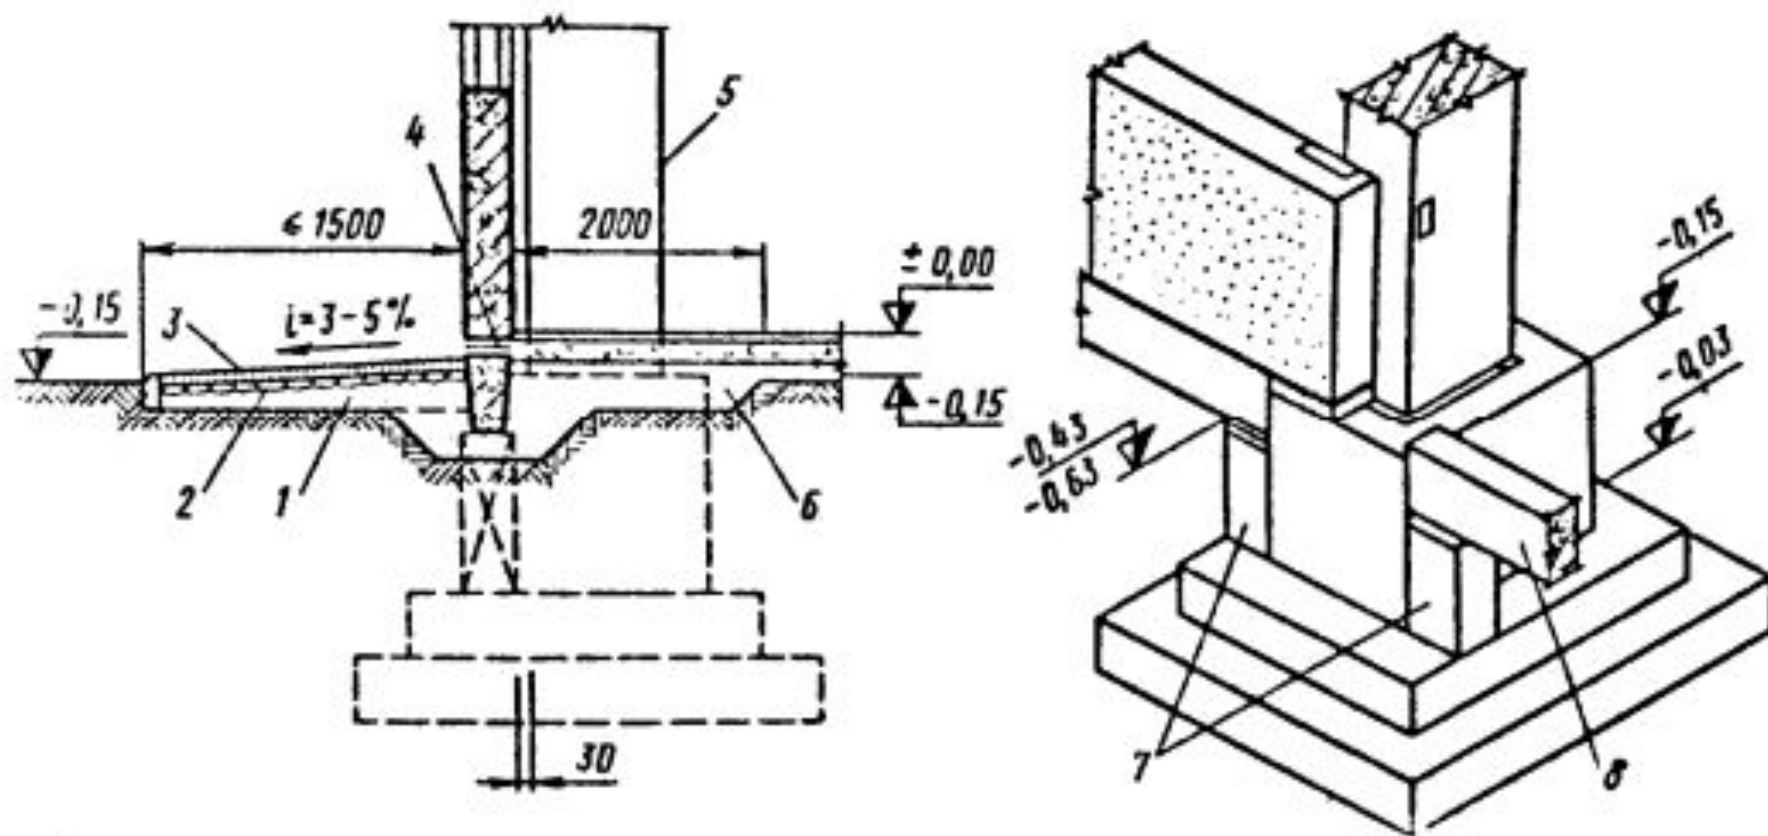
Схеми деталей фундаментів: 1 - пісок; 2 - щебень; 3 - мощення; 4 - гідроізоляційний шар; 5 - колона; 6 - утеплюючий шар шлаку; 7 - залізобетонні стовпчики; 8 - фундаментна балка
